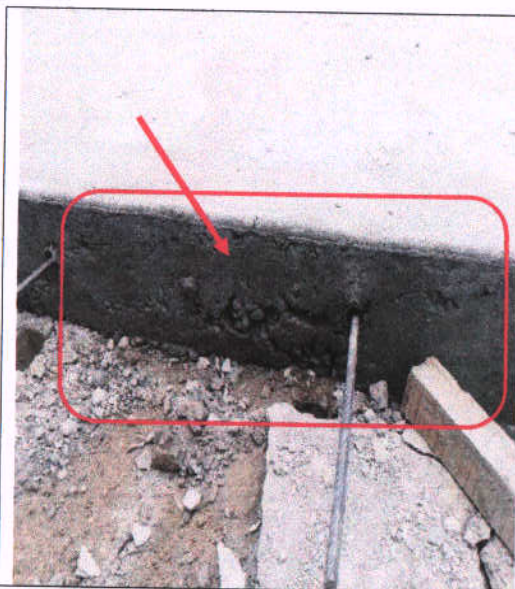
Se observa cangrejeras (vacíos) en el concreto de pavimento
